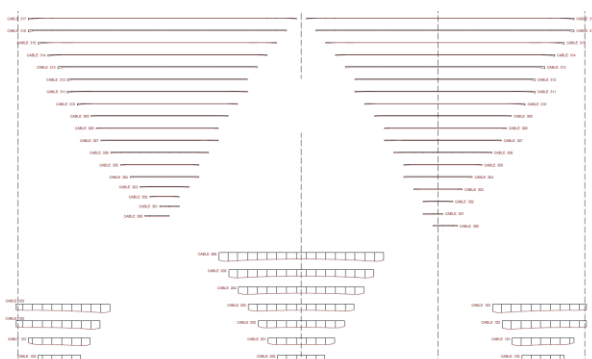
Elevación de los cables de pretensado de proceso y de servicio del Puente Colimes.
